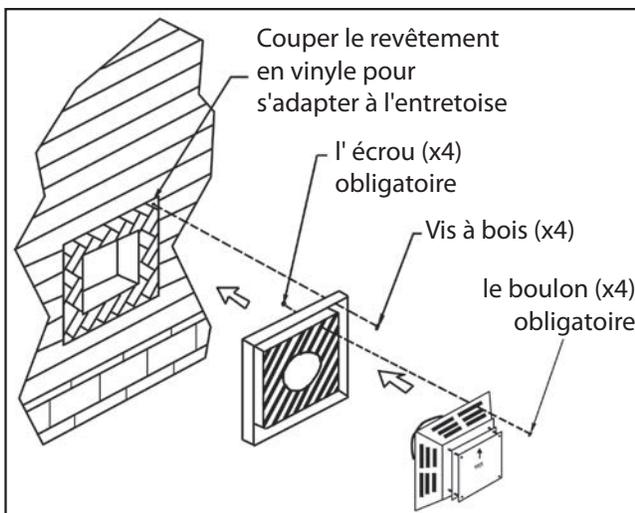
Installation Vent Cap avec revêtement de vinyle impasse.
